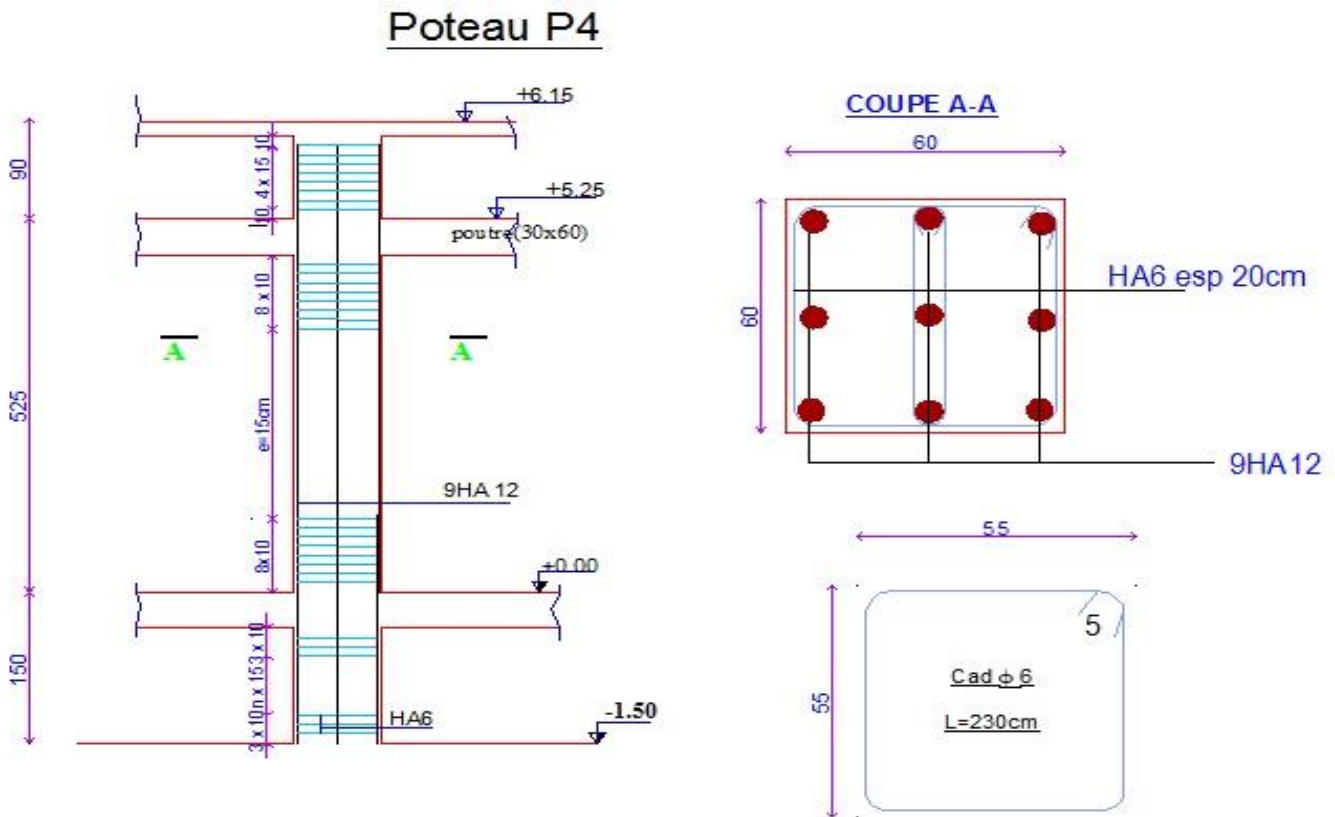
Plan de ferrailage d'un poteau(P4) central côté entrepôt
